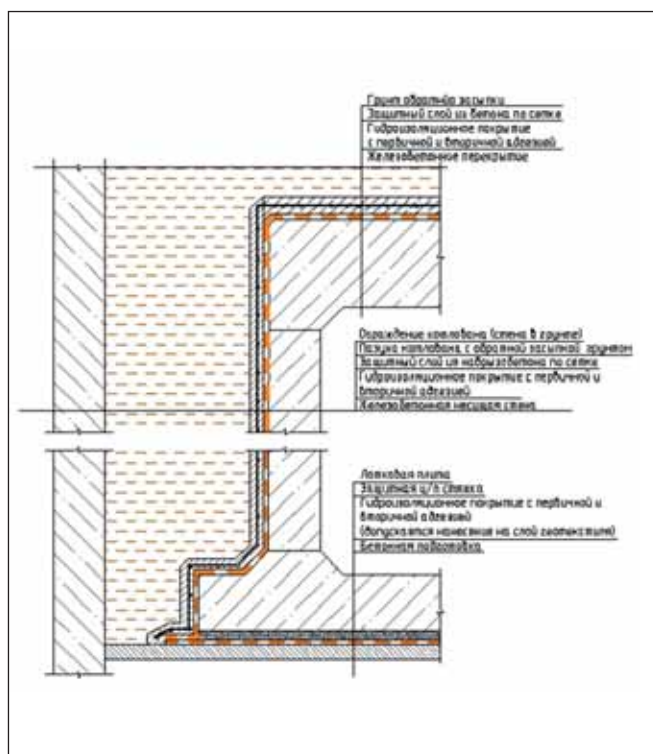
Схема устройства гидроизоляционной системы при открытом способе работ с пазами для обратной засыпки грунтом [11]
